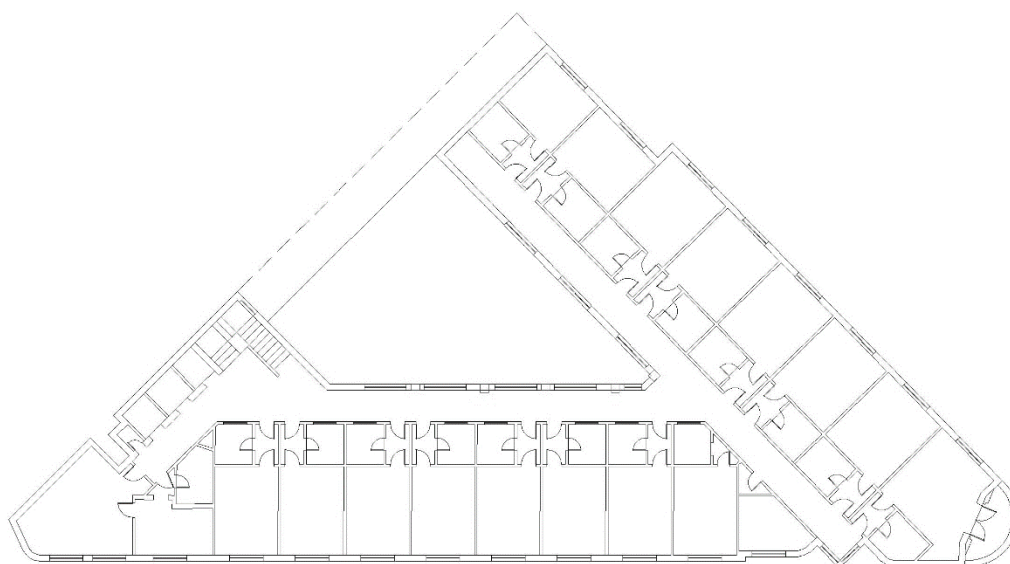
Planta Baixa – 1º ao 6º pavimento.
